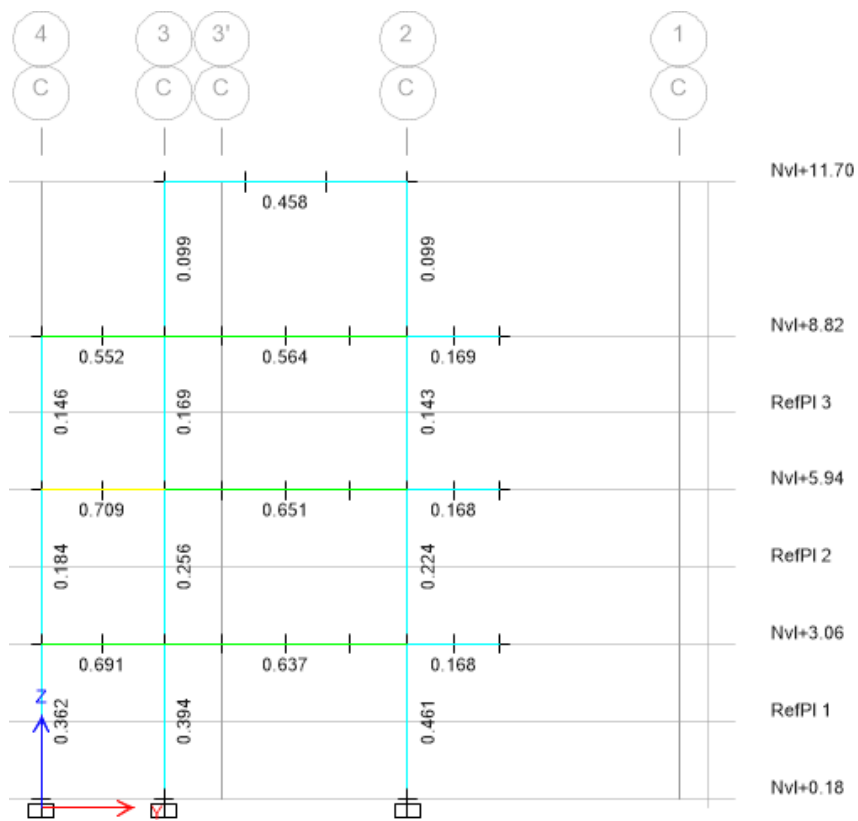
Diseño de columnas huecas, vigas principales del eje C
